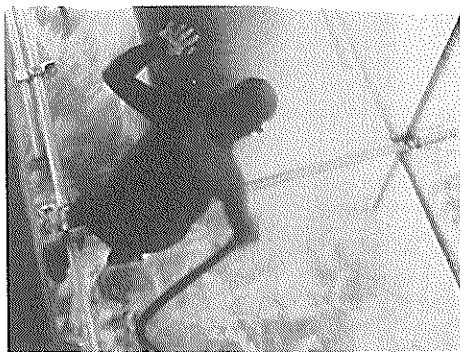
水中硬化型ライニング工法の作業状況 (杭 No. 9~11)
